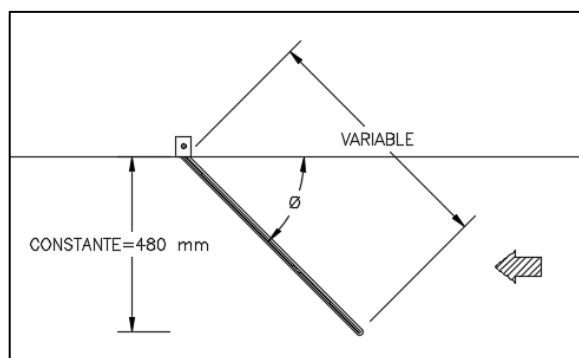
Vista en planta de longitud de espigón de prueba. Fuente: Propia
